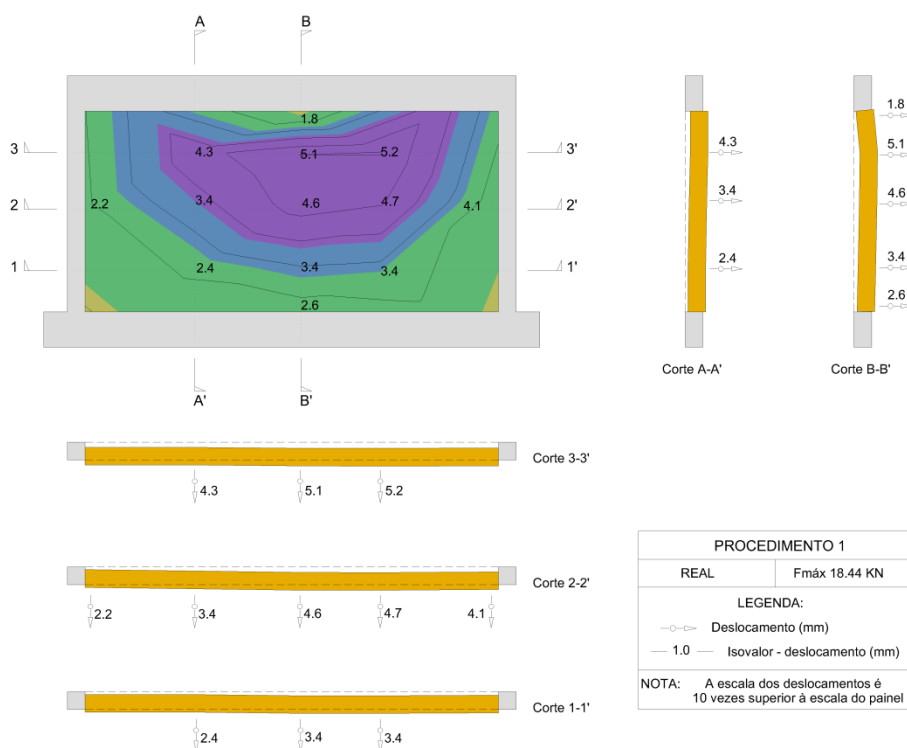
Isovalores da parede ensaiada - Procedimento 1. Ensaio fora do plano, Wall_JAR_02.
